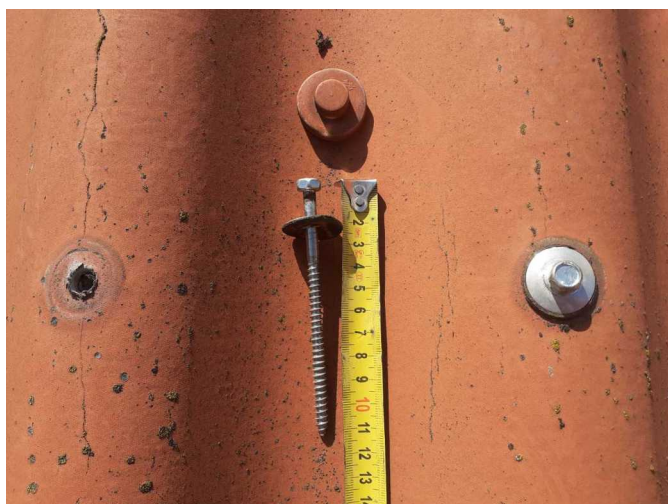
/ Kotevní prvek střešní krytiny s ochrannou plastovou čepičkou
